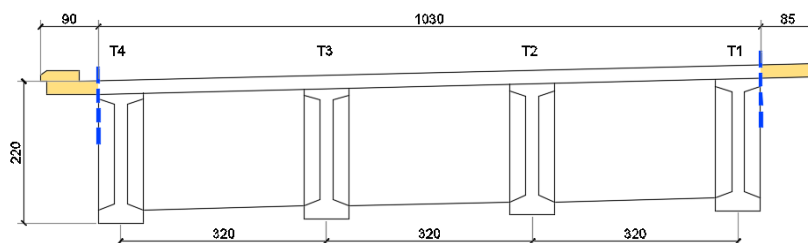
Sezione trasversale alleggerimenti cordoli
